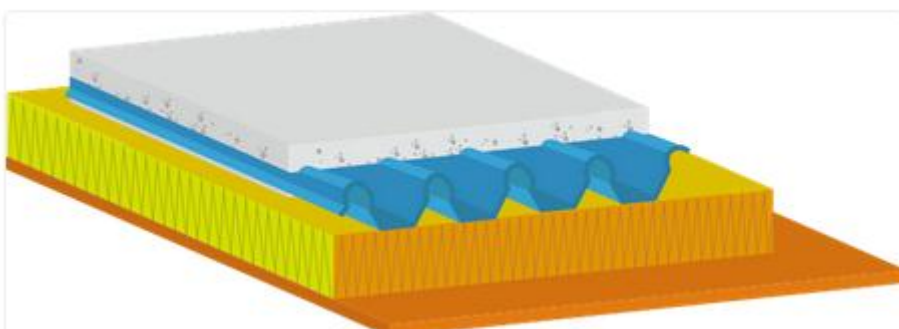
schématisation dalle avec plafond coupe-feu et isolation
